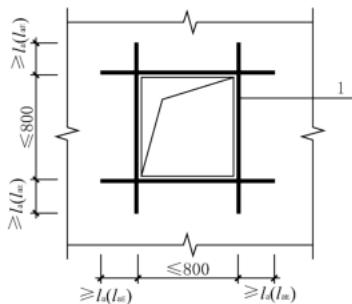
预制剪力墙洞口补强钢筋配置示意
